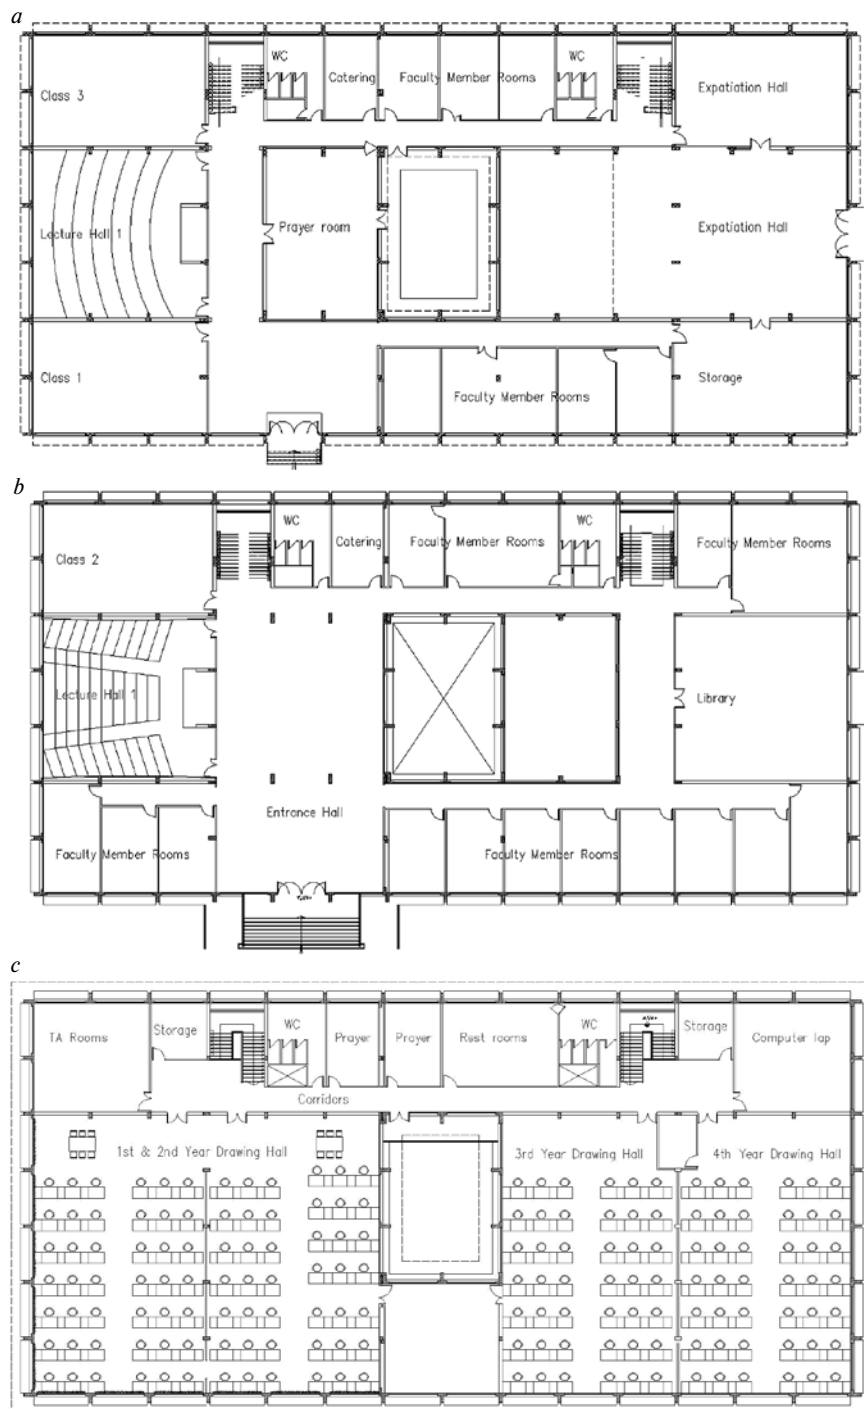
Здание архитектурного департамента инженерного факультета Университета Асьют, поэтажные планы [8]: а – цокольный этаж; б – план первого этажа; с – план первого этажа
